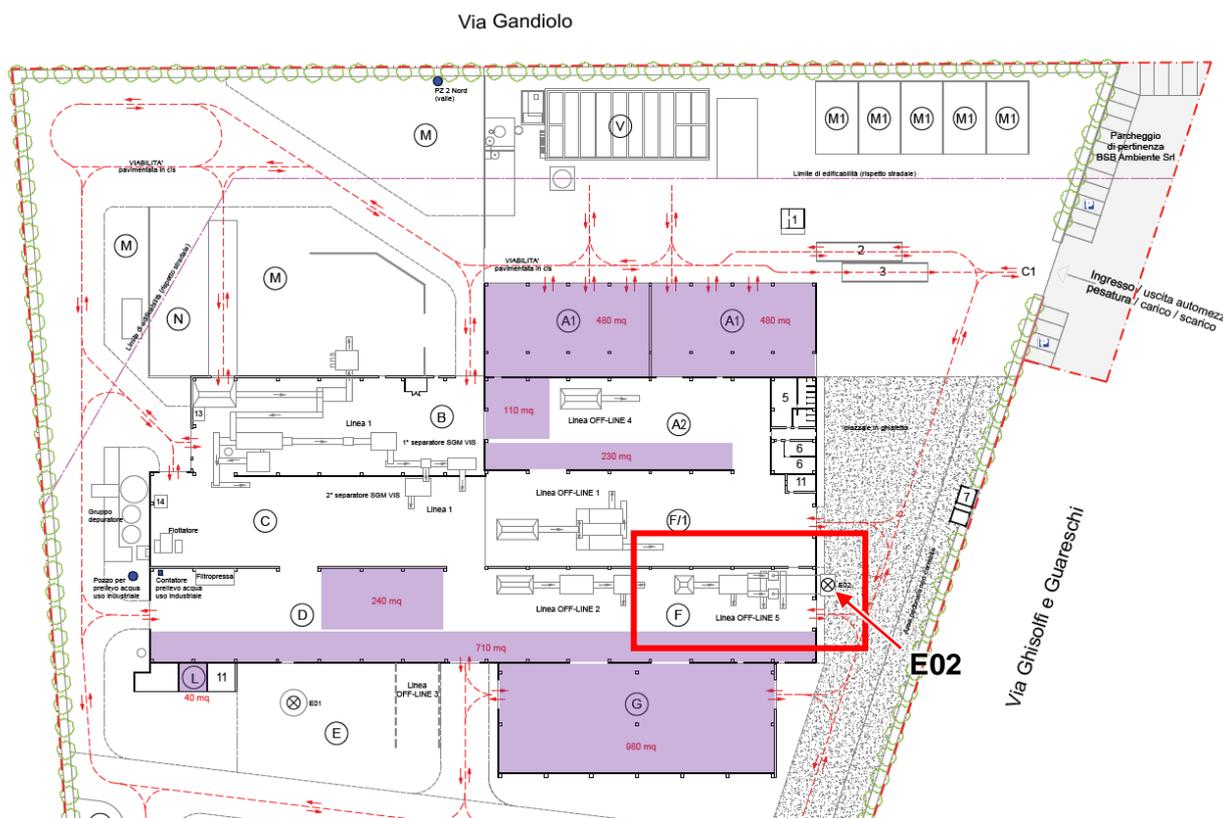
Stralcio elab. “Tav. 01 Planimetria generale – Rev. 5 maggio 2025 (Stato di progetto)”.
